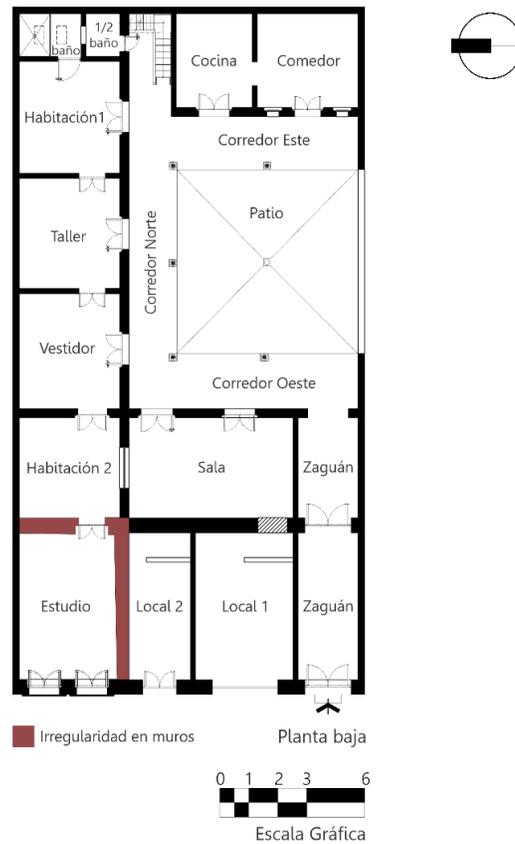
Plano de Planta Baja, donde se muestra la irregularidad en muros del estudio. Elaborado por KNV.
